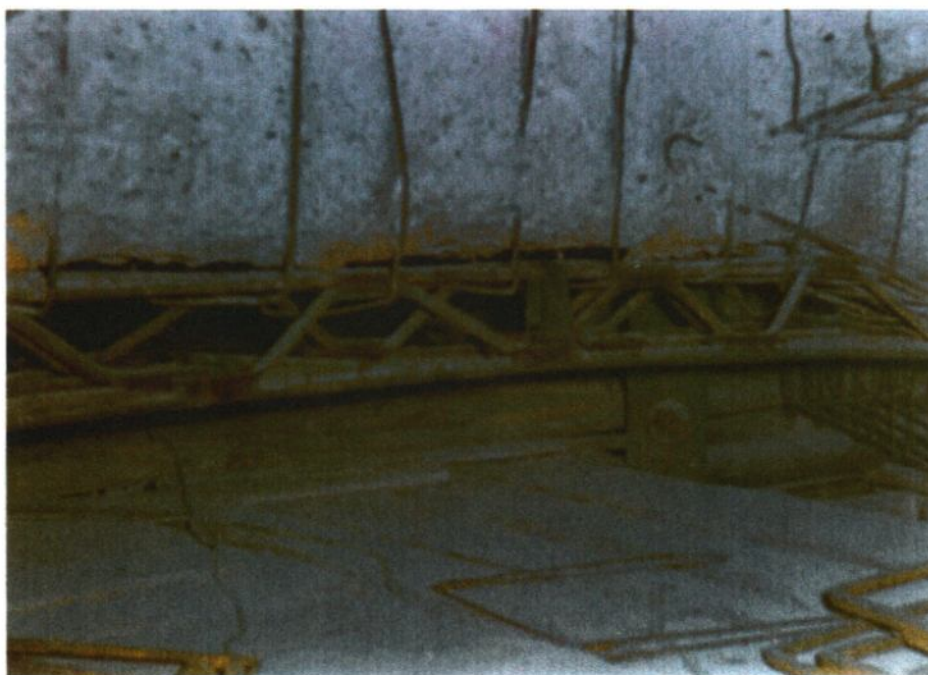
Element degradat prin aplicarea conectorilor dintre armături
